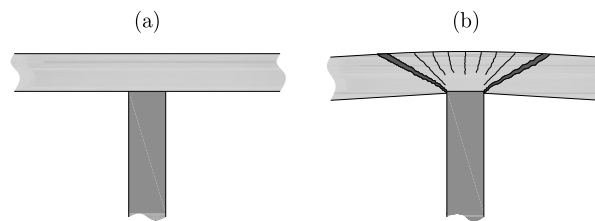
Détail du système plancher-dalle ou pont-dalle dans la région d'appui (a) et rupture par poinçonnement de la dalle autour d'une colonne (b)
